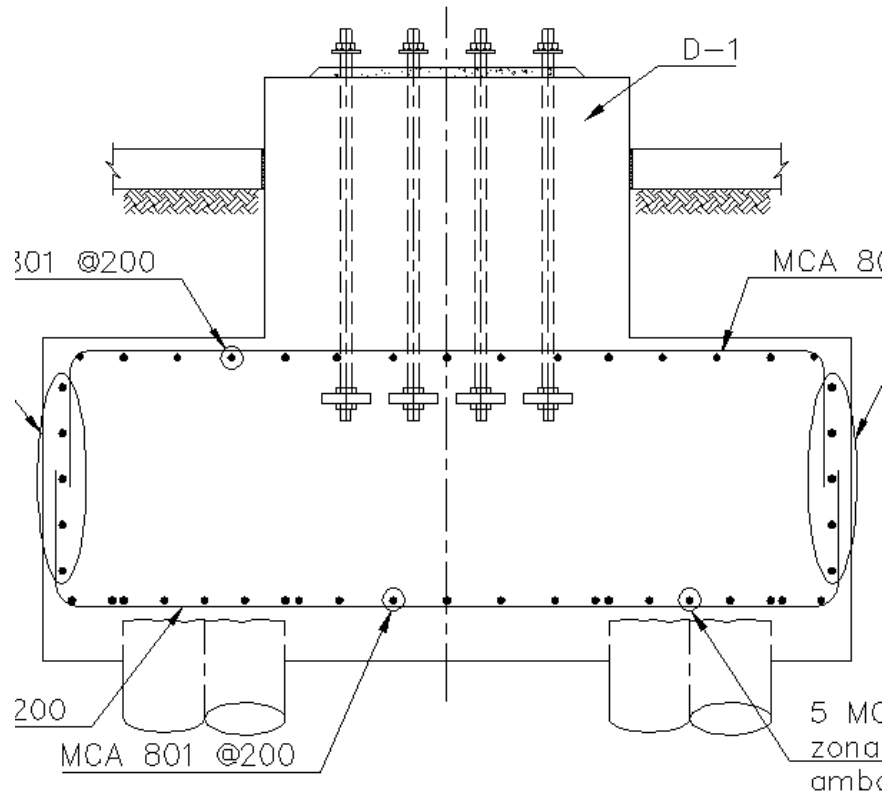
Armado de acero para cabezal y dado de concreto.
